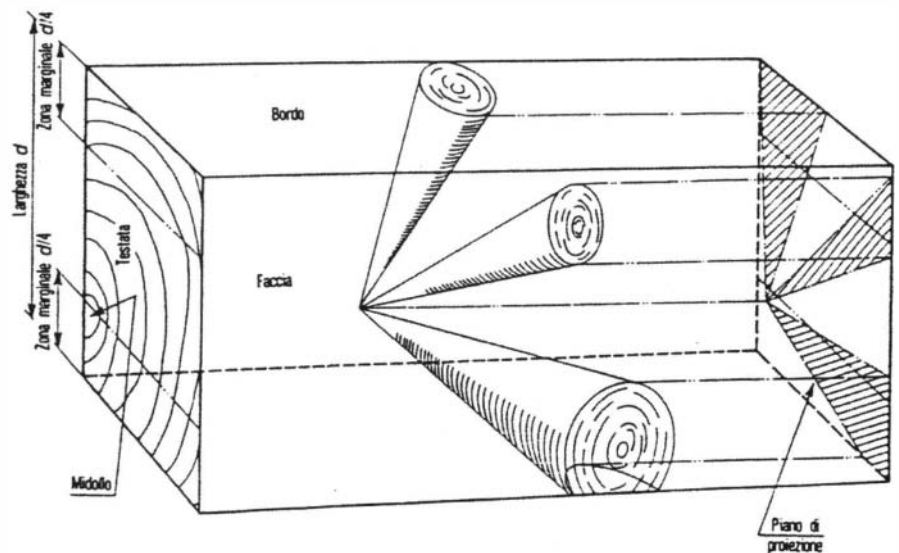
Vue montrant en trois dimensions, un groupe de nœuds sur une pièce de bois et leur projection sur un plan de section transversale
